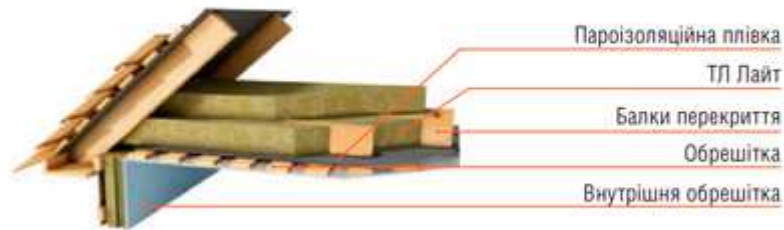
Внутрішнє утеплення стелі на горизонтальних перекриттях[20]
